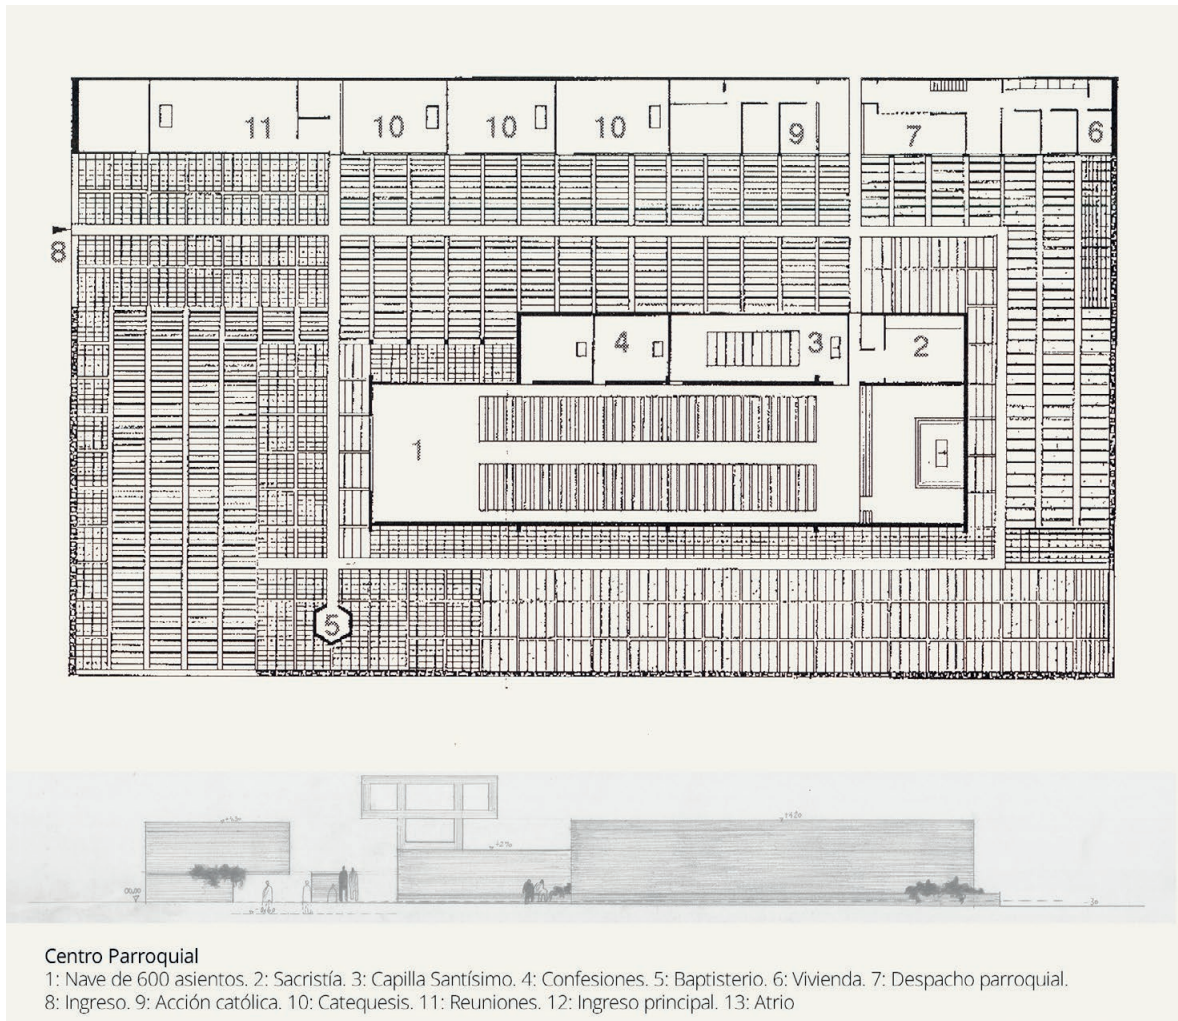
Sáenz de Oíza y Sierra. Anteproyecto de centro parroquial en el poblado dirigido de Entrevías, 1958. Planta y alzado.
